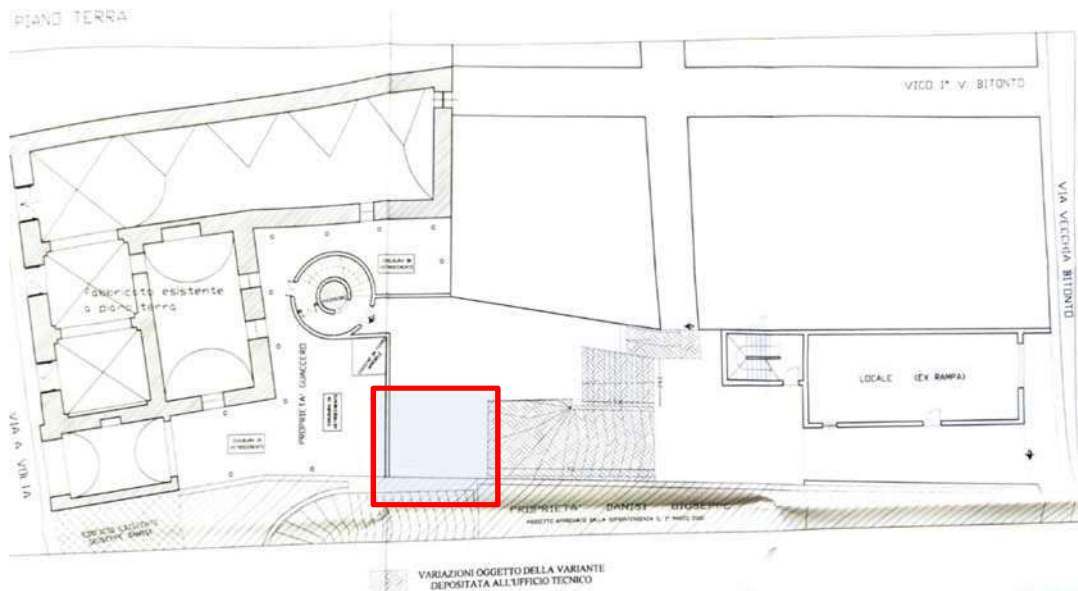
BENE H- Stralcio planimetria di progetto approvato P.d.C. n. 3389 del 23.12.2002 e
